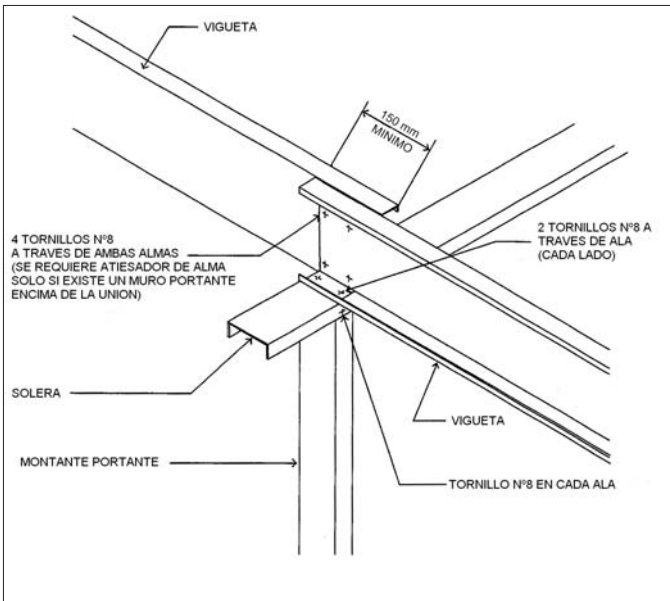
Vigueta Empalmada Apoyada en Muro Portante Interior
